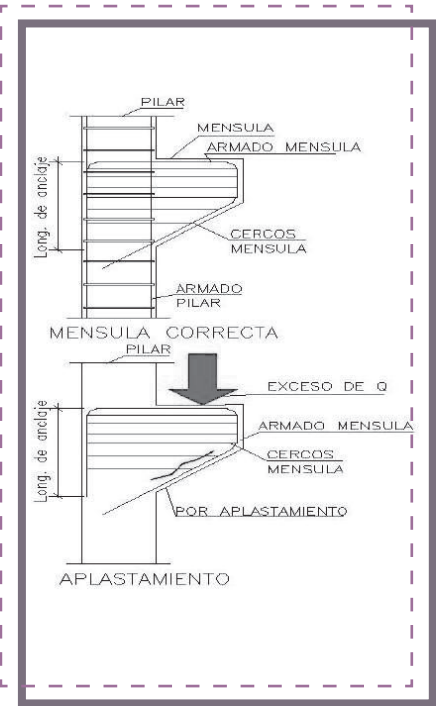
Esquema de fisuraciones por compresión en una ménsula de hormigón armado.
